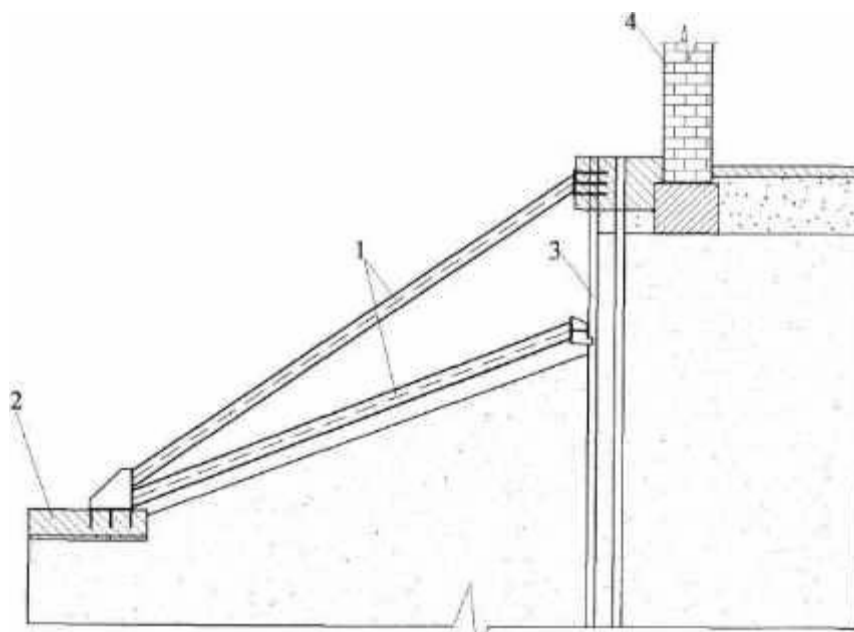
Усиление подкосами: 1 - подкосы из металлических труб; 2 - пионерная плита; 3 - ограждение; 4 – конструкции окружающей застройки
